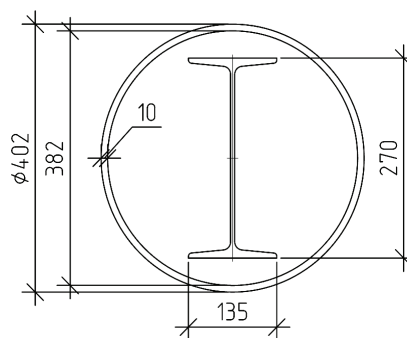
Схема колонны круглого сечения с жестким внутренним армированием (вариант 2) – двутавр в труботетоне.
